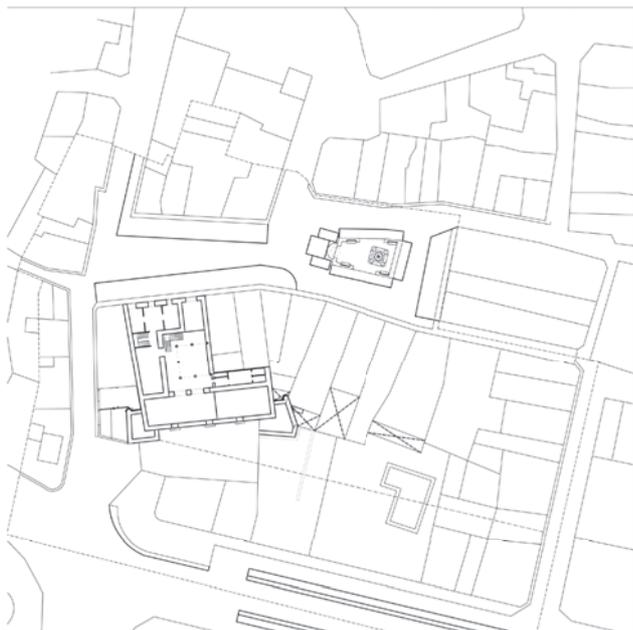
Plano de situación, donde se aprecia el patio y el patio renacentista mutilado por los edificios de viviendas.
